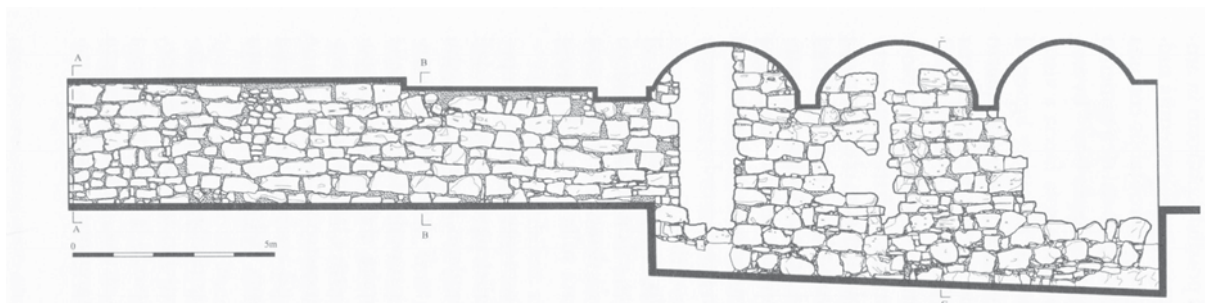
Centro studi CRV, muro di terrazzamento (da BONAMICI 2008)
